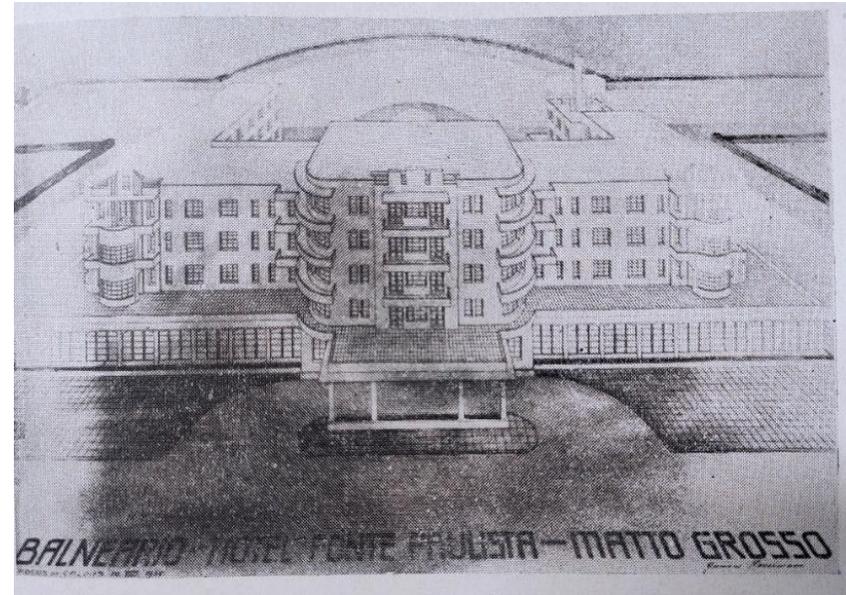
Perspectiva da fachada principal do projeto para o Hotel das Águas Quentes não executado.
